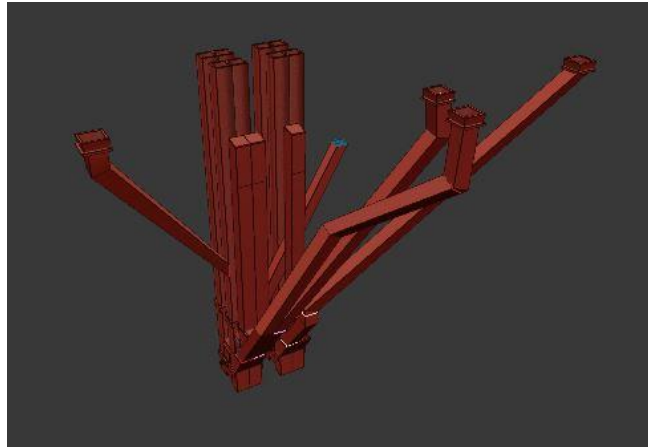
Canalizaciones de dos parejas de elevadores de la planta baja.
